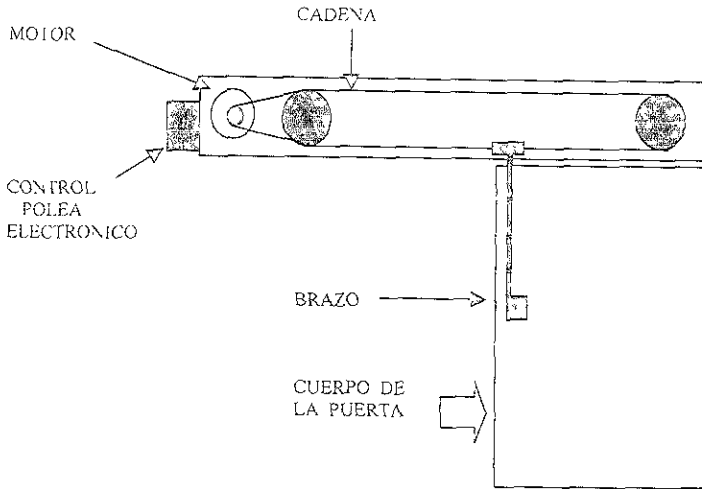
Mecanismo de tracción de la puerta de acceso vehicular.
